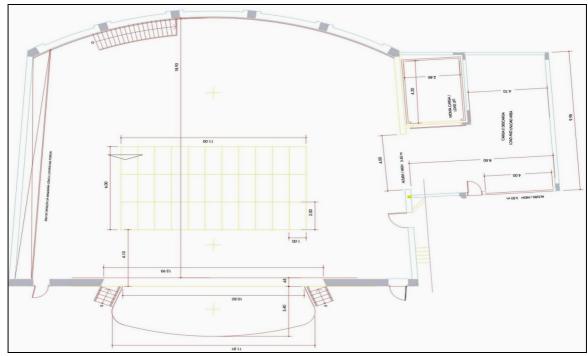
Teatro Alfa – Planta parcial do Palco. Fonte: SÃO PAULO (2011)
